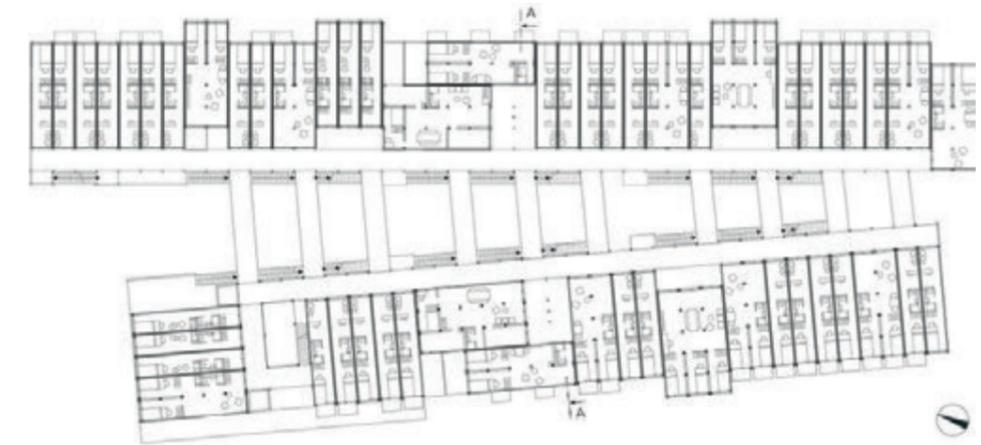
Grundriss 2.OG des Studierendendorfes EBA Berlin Neukölln, ohne Maßstab (Greve 2016)
